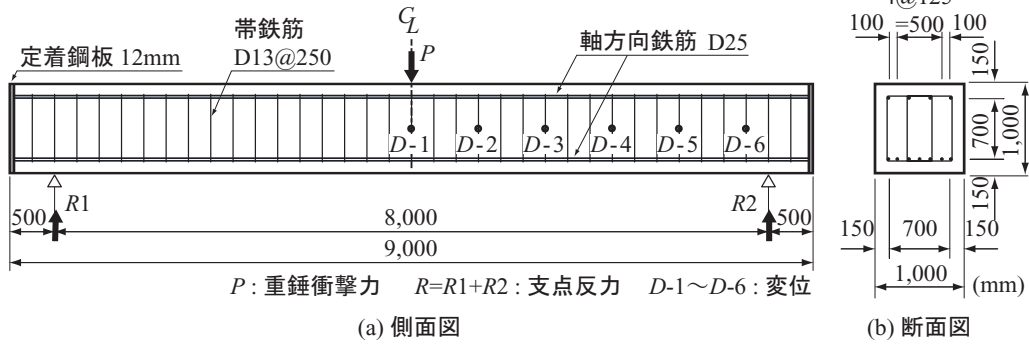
大型 RC 梁試験体の形状寸法および配筋状況
